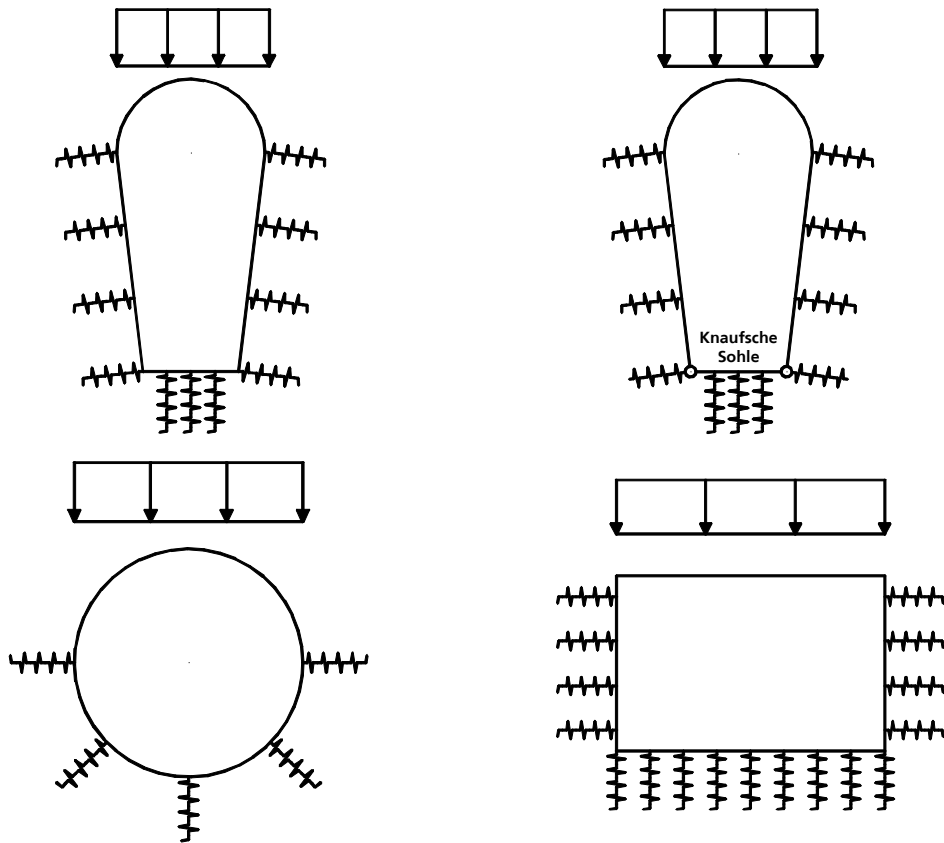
Kanäle mit grosser Überdeckung, Fall 1
